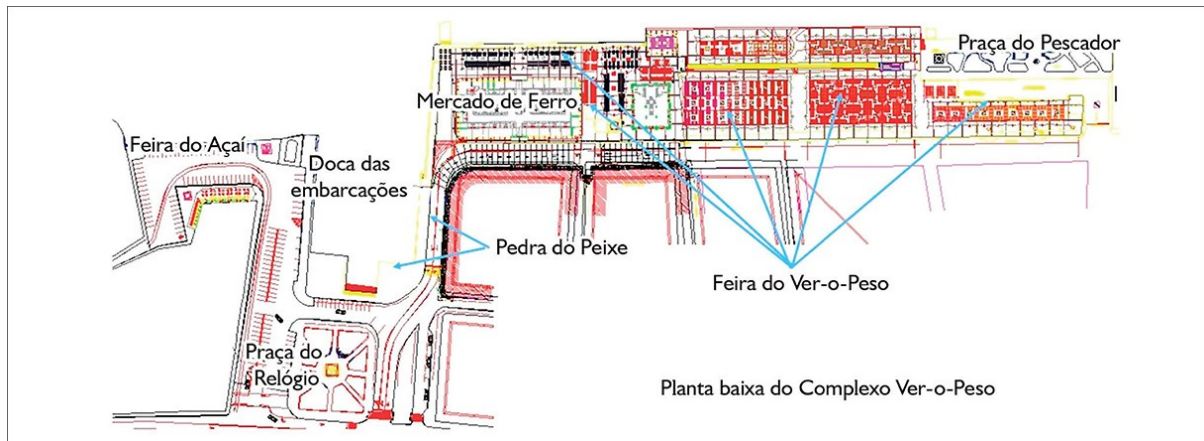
Planta baixa esquemática do Complexo do Ver-o-Peso.
